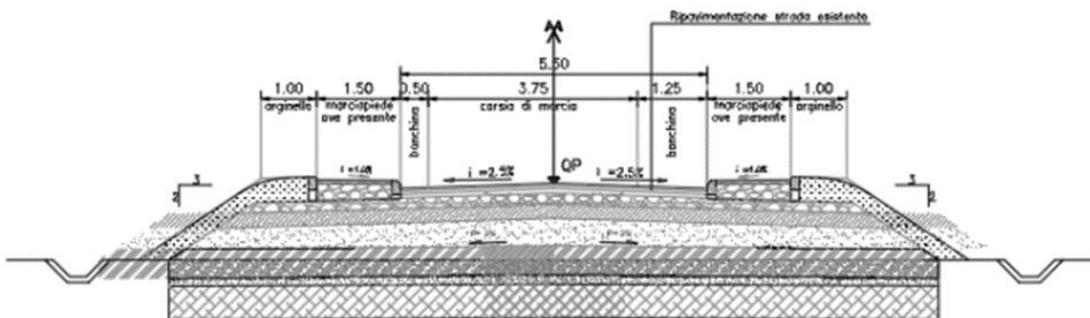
sezione tipo per asse oggetto di sola ripavimentazione, a senso unico, con corsia da 3,75 m e banchine laterali
